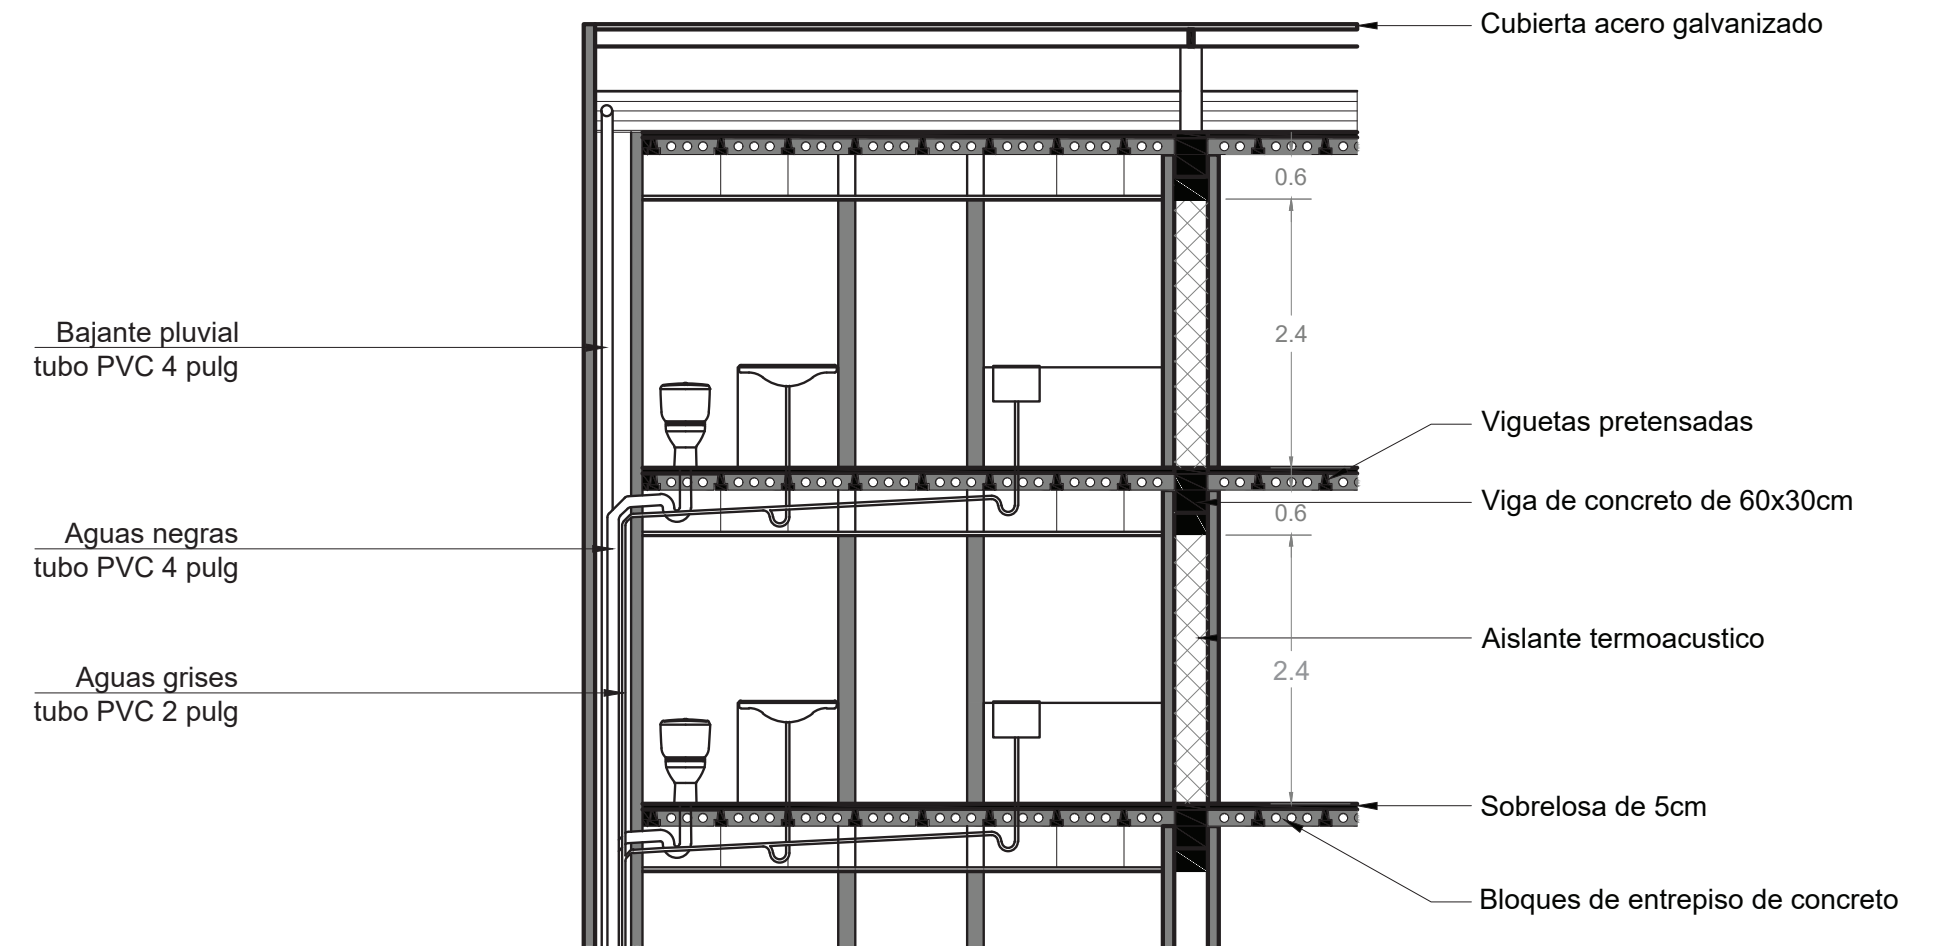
Detalle estructural tuberías mecánicas y cielorraso. Fuente: Elaboración propia.
